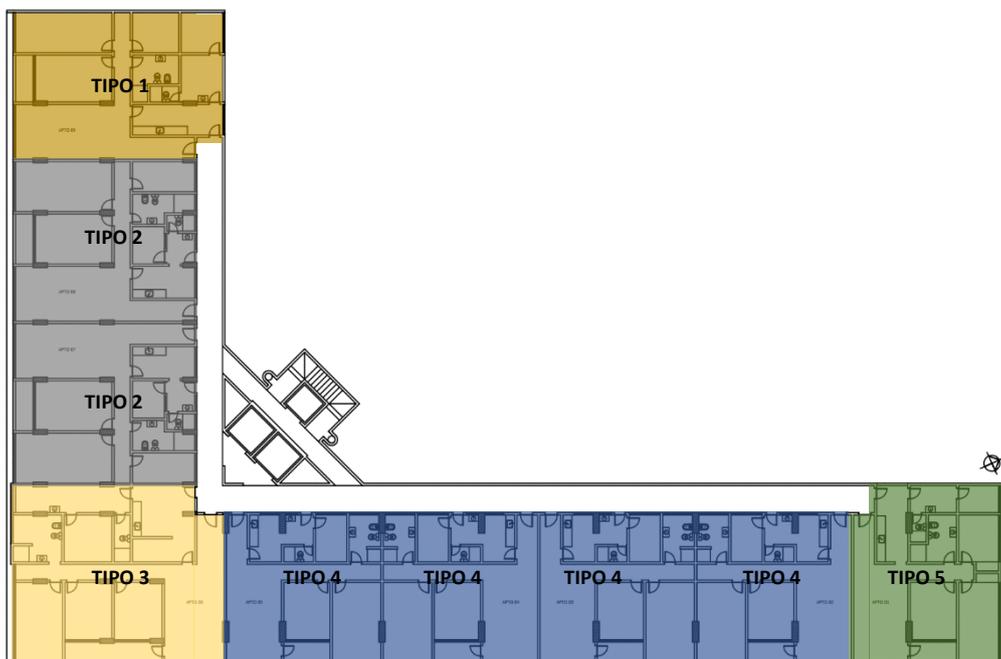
Planta baixa do pavimento-tipo do edifício de apartamentos Caricé em 1964
